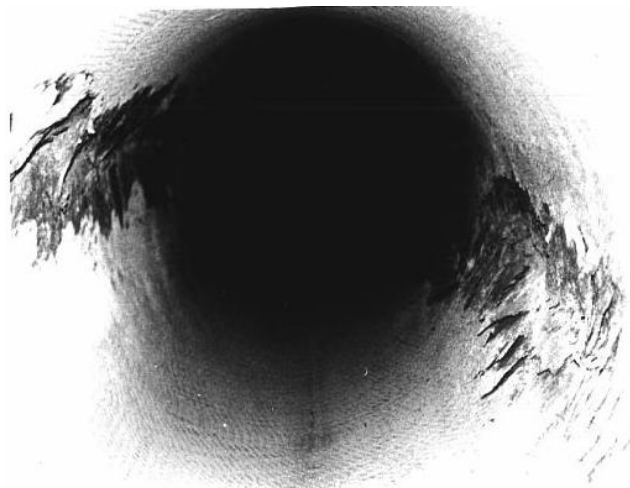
Exemplo de spalling nas paredes laterais (Hoek et al., 2000)
